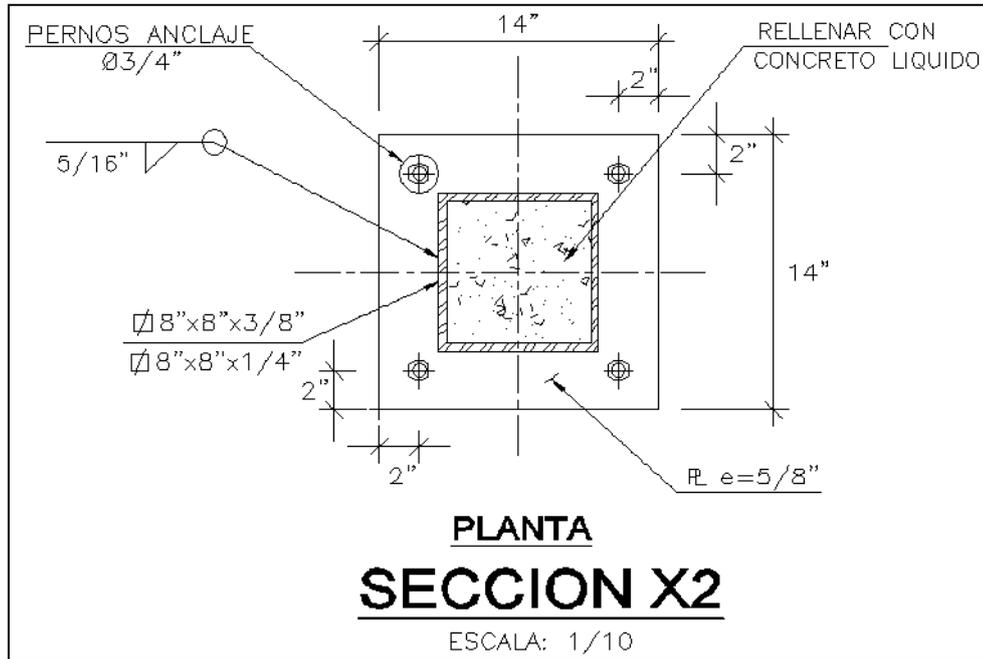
Sección de acero tubular. FUENTE: Elaboración Propia
